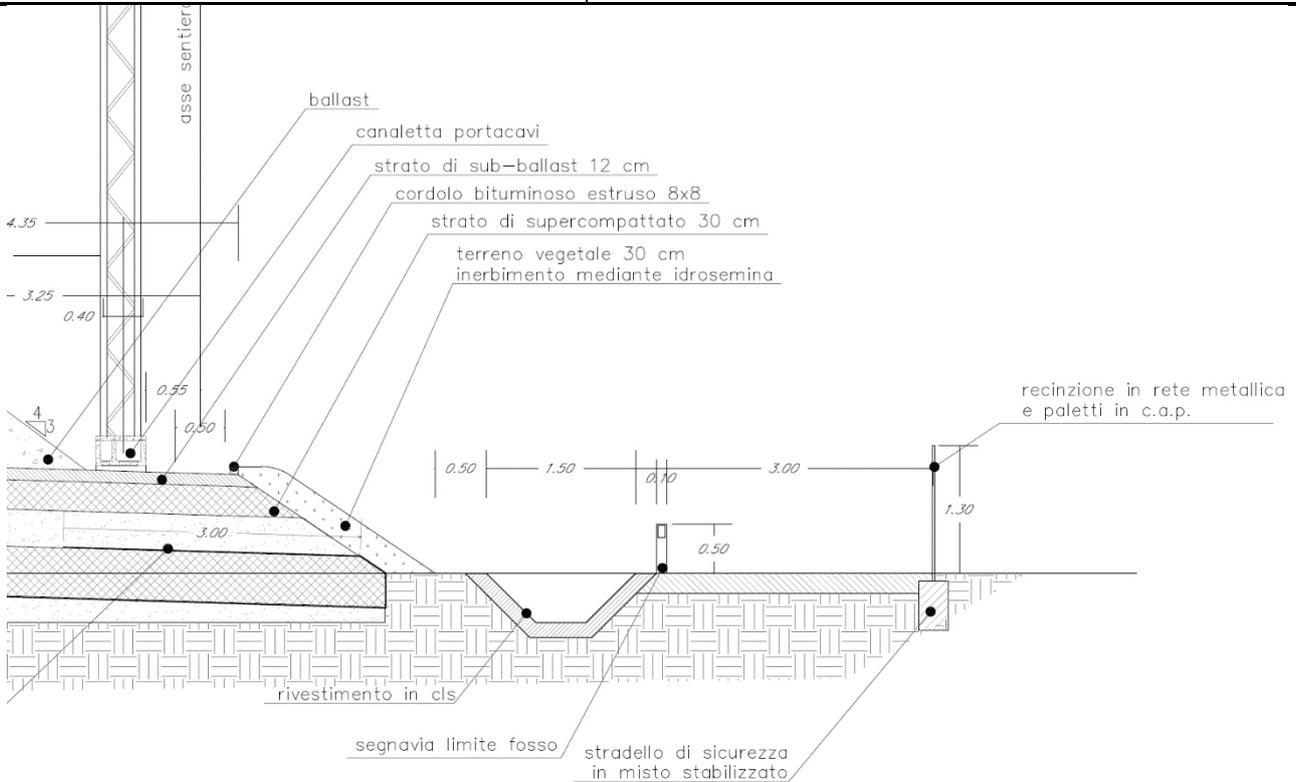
Dettaglio alla base del rilevato con pista di servizio
